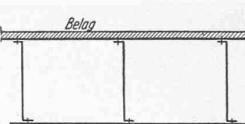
Leichte Decke als Stahl-Hohlkörper ausgebildet
